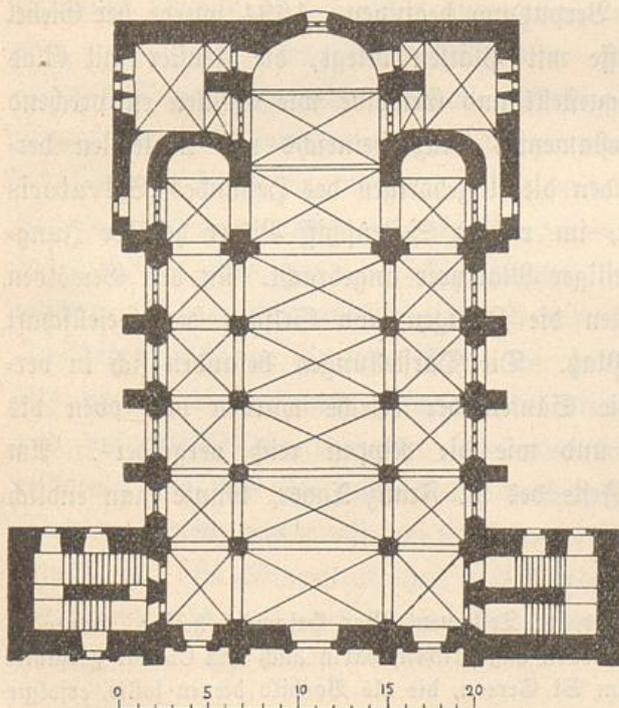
Bonn. Namen-Jesuitenkirche. Grundriß.
